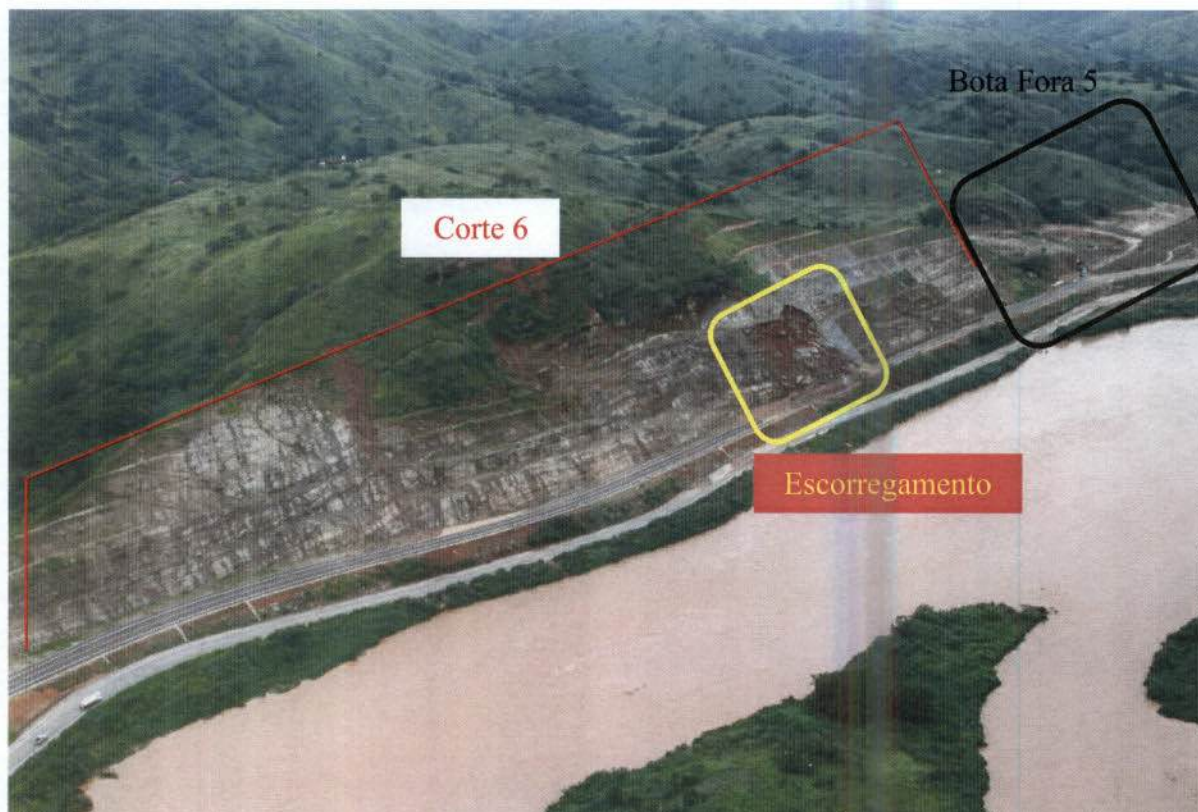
Vista, em primeiro plano, do escorregamento do talude do Corte 6 em meados de outubro de 2011 e, em segundo plano, do bota-fora 5 da BR393.
